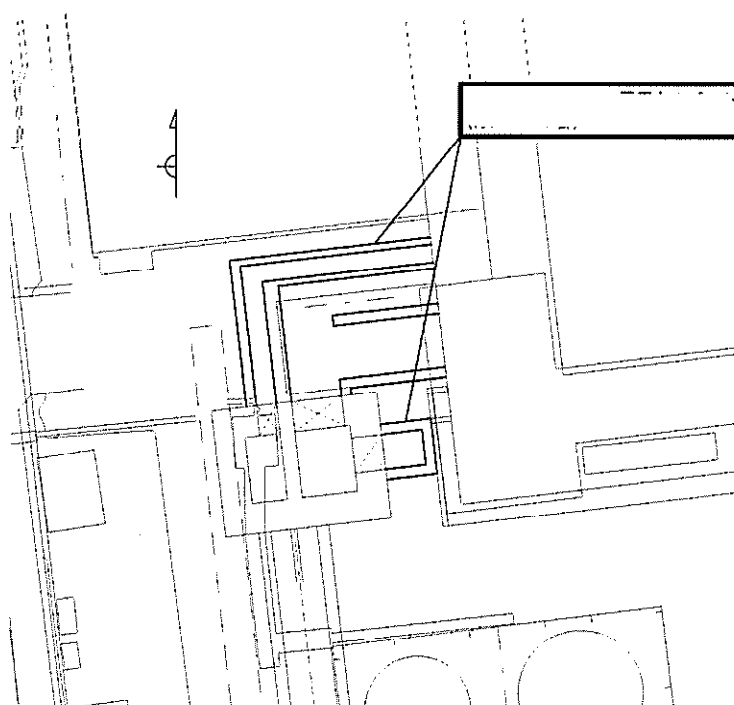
(2) 常設代替高圧電源装置用カルバート（カルバート部）の平面配置図（拡大図）
